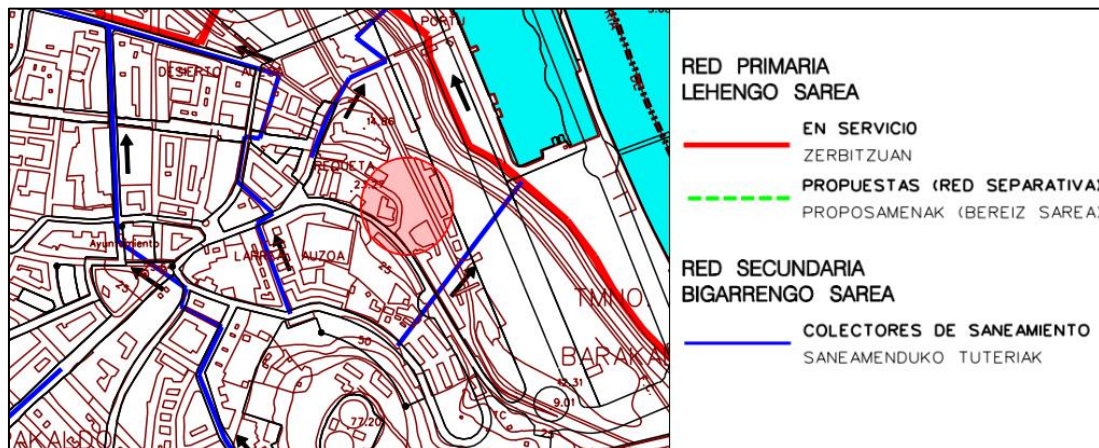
Red de saneamiento de Barakaldo. Fuente: PGOU
